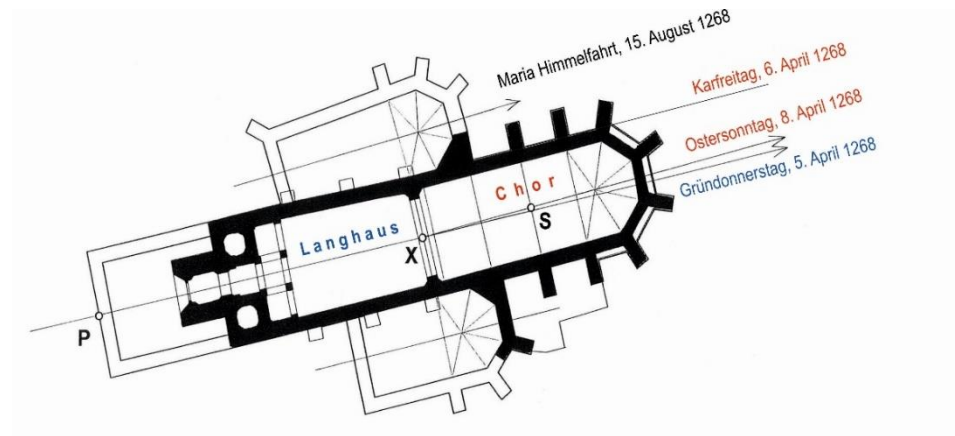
Marchegg Pfarrkirche; Grundriss mit ihren Orientierungstagen im Gründungsjahr 1268. Achse Langhaus am Gründonnerstag, Flucht Nordwand Chor am Karfreitag, Achse Chor am Ostersonntag und Achse Nordkapelle zu Maria Himmelfahrt.
